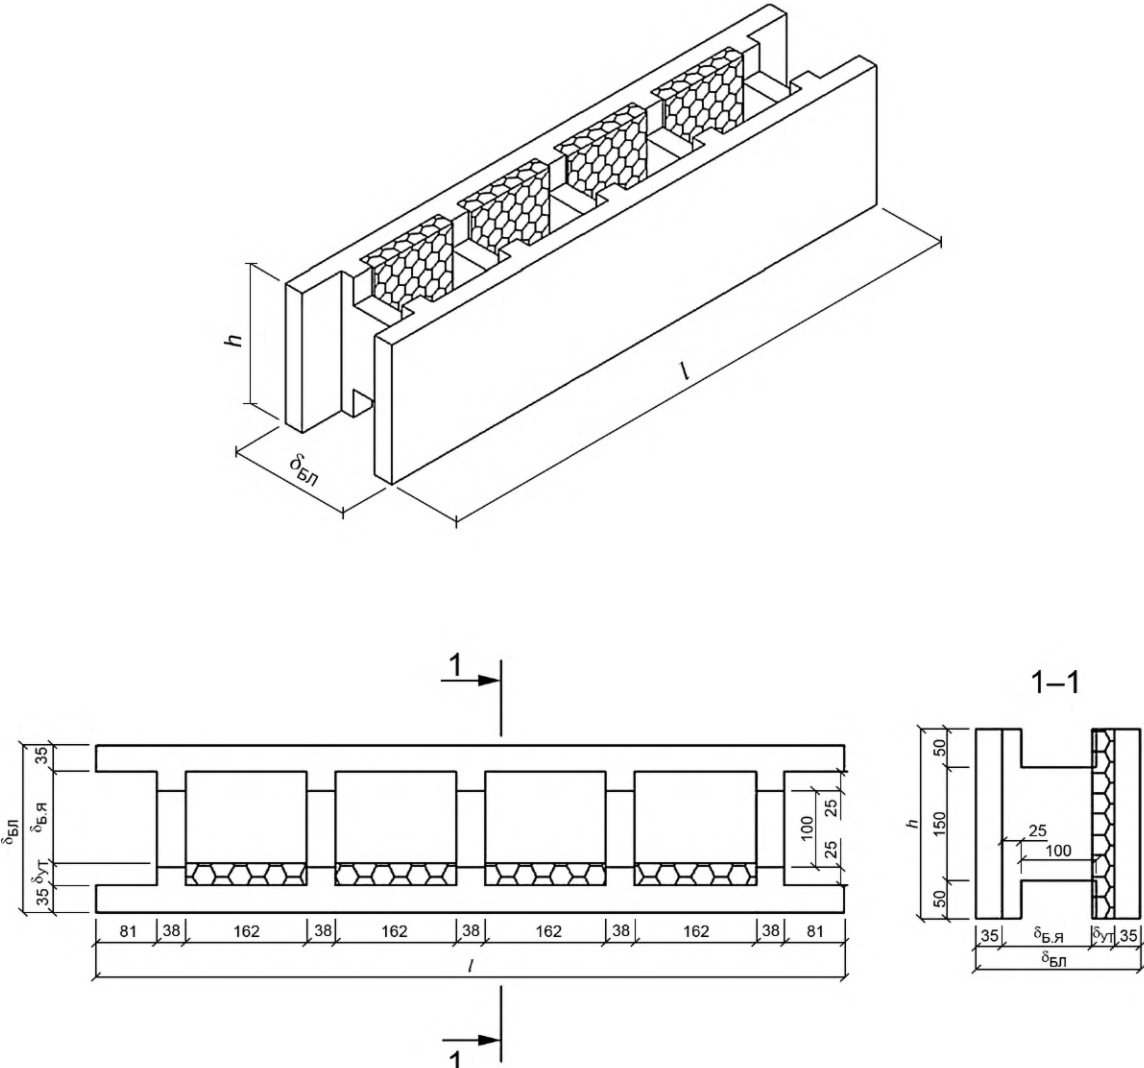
Блок наружной стены рядовой утепленный (НС-Р-УТ-22/12)
